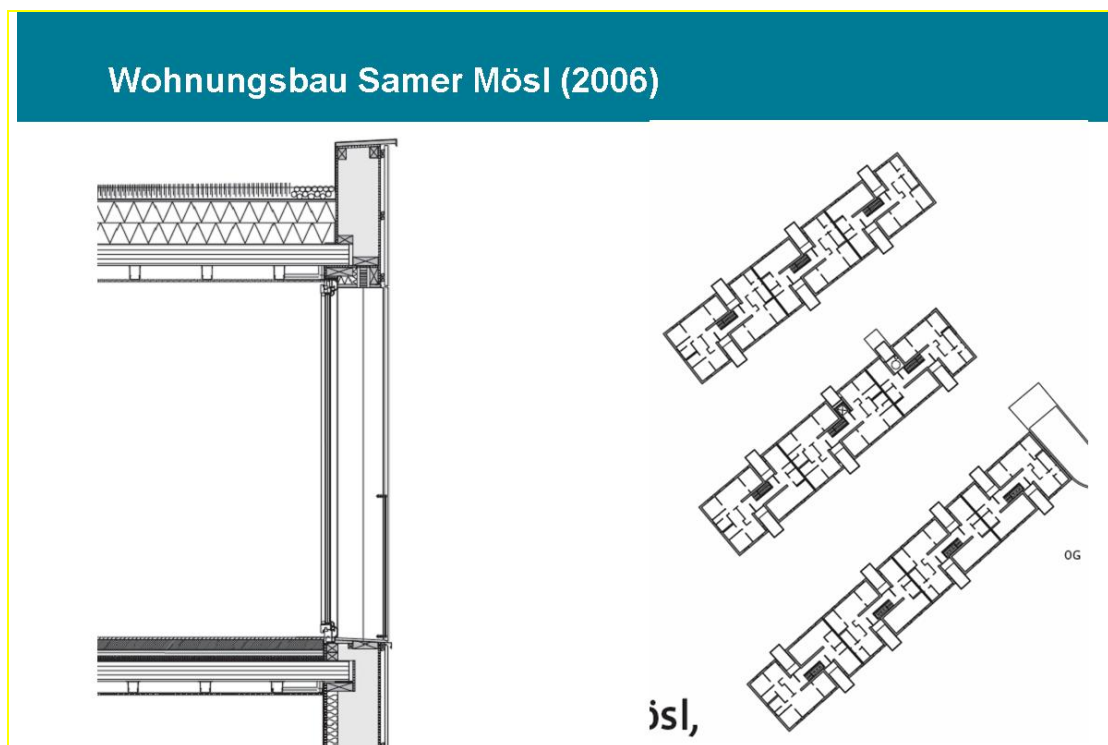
Wohnungsbau Samer Mösl, Grundriss, Detailschnitt
